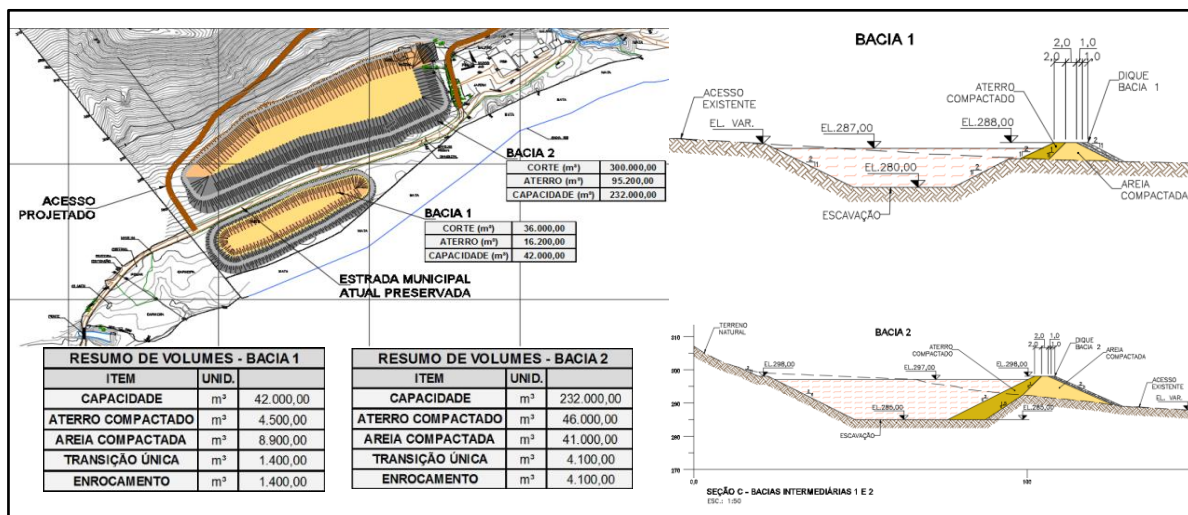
Bacias 1 e 2 – Plantas, Seções e Detalhes
